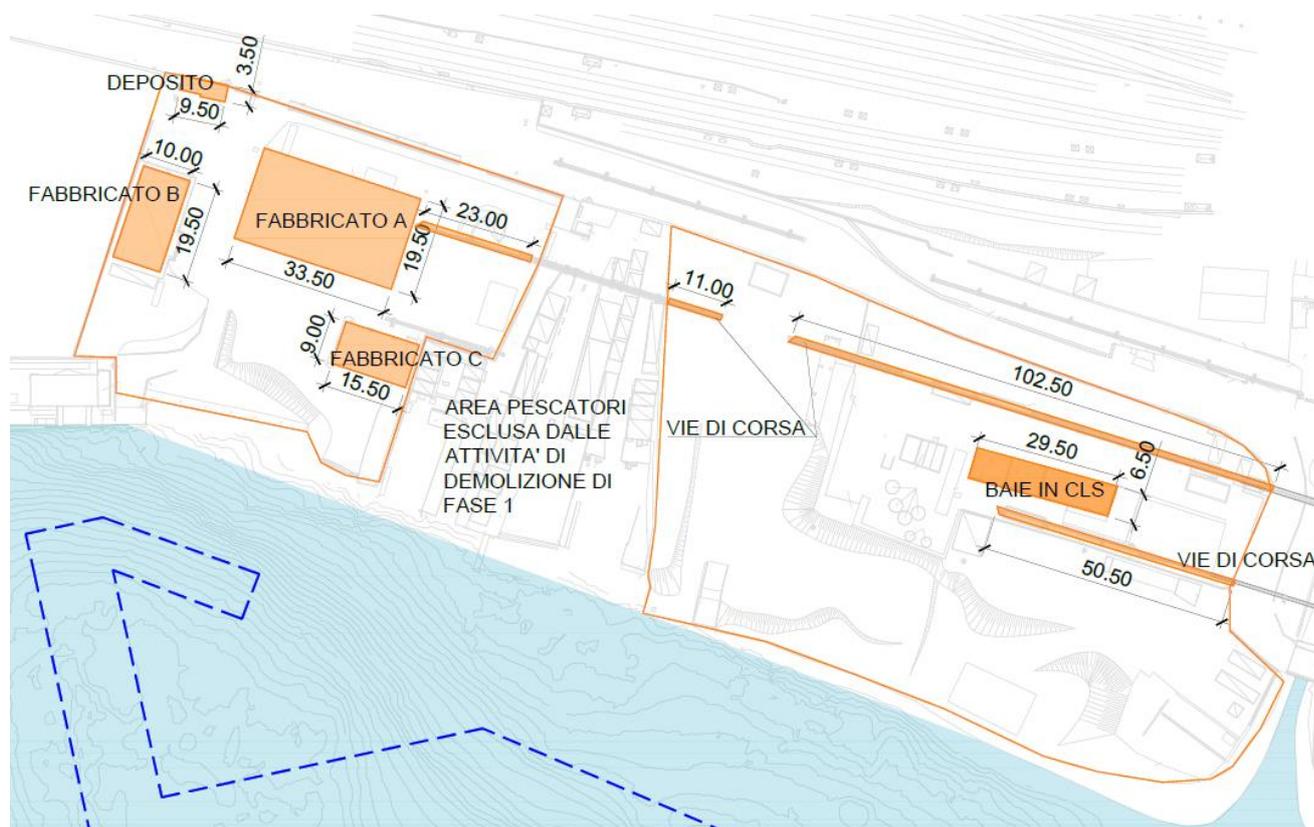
Planimetria delle demolizioni area nord realizzanda Cassa di Colmata
